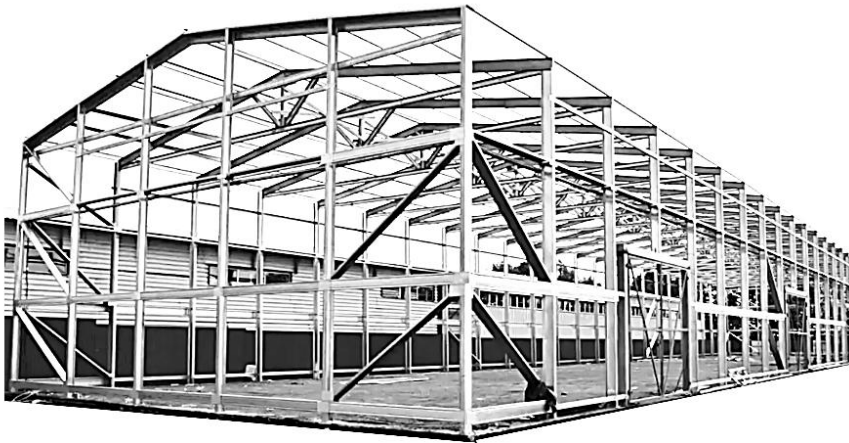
Каркас одноповерхової будівлі з металевих конструкцій.
